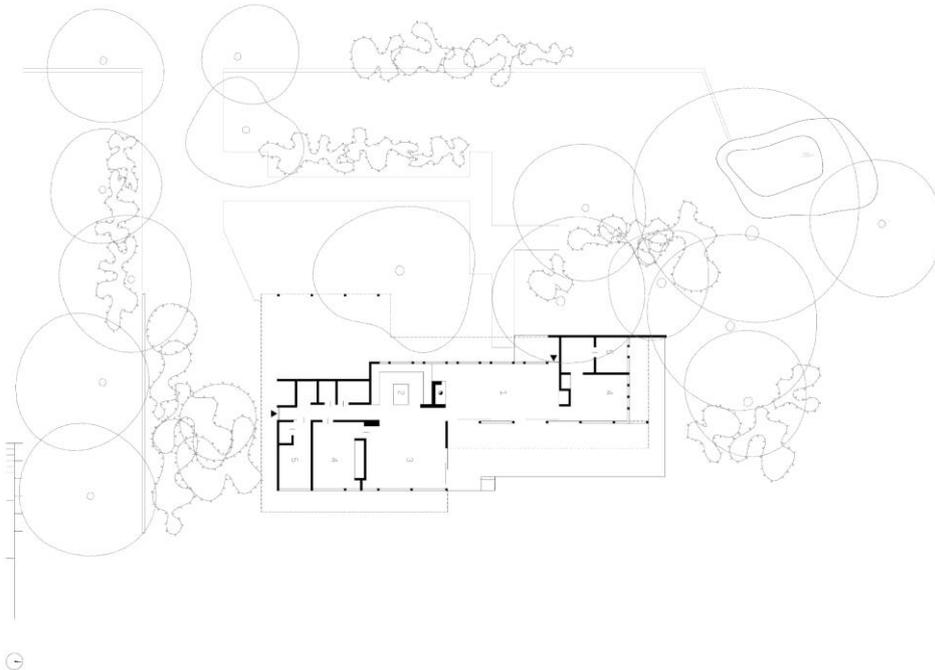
Planta de la Oyler House, Lone Pine, 1959.
